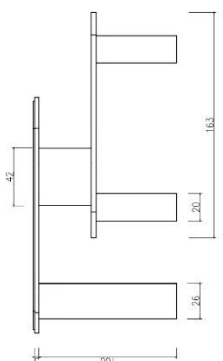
Ruang Terpilih 1 (Introduction Room)
